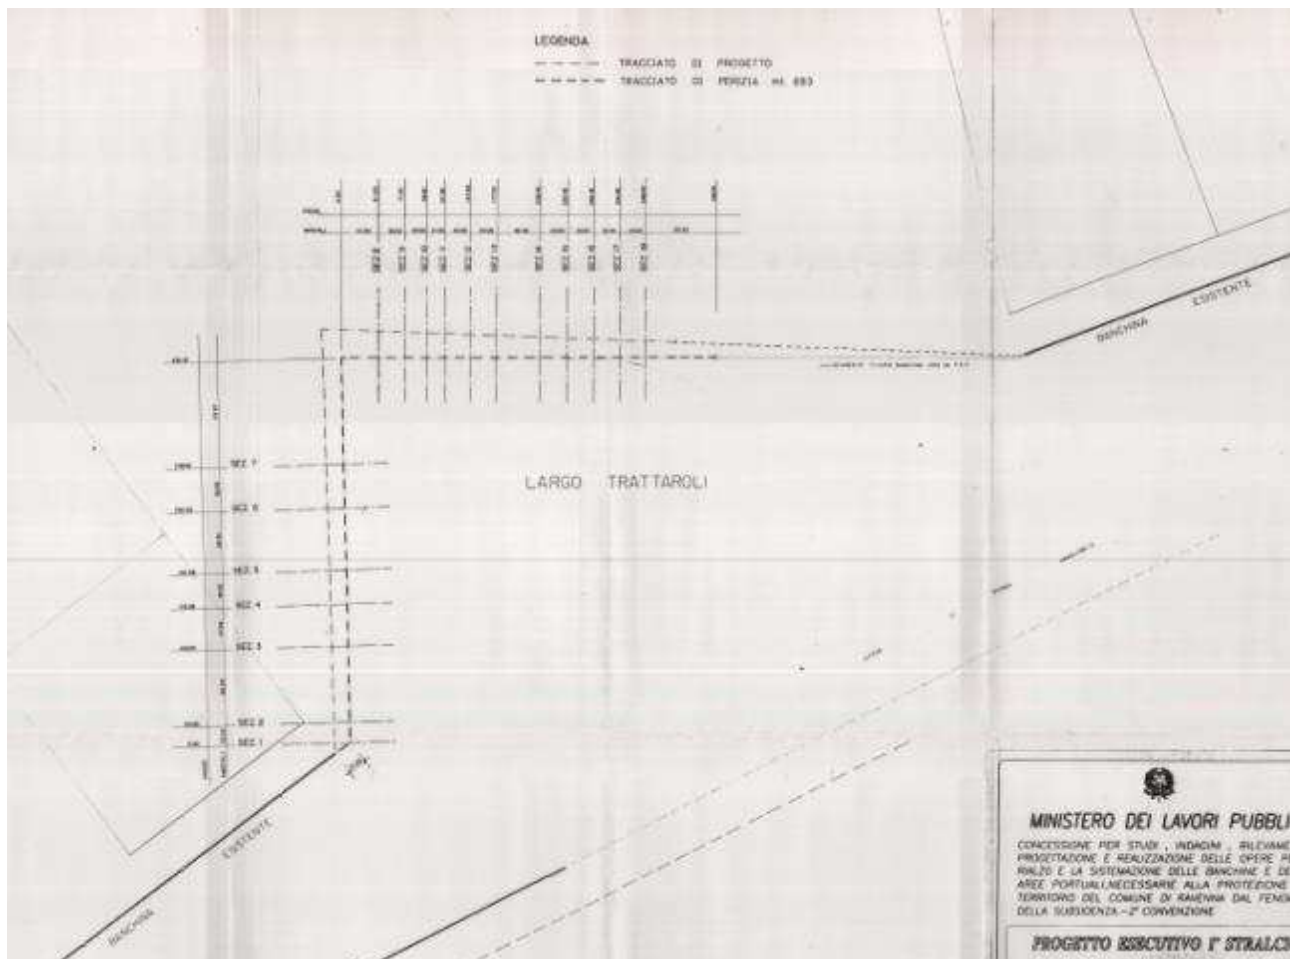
Planimetria dell’area con il tracciato di banchina previsto dalla Perizia del 1995
